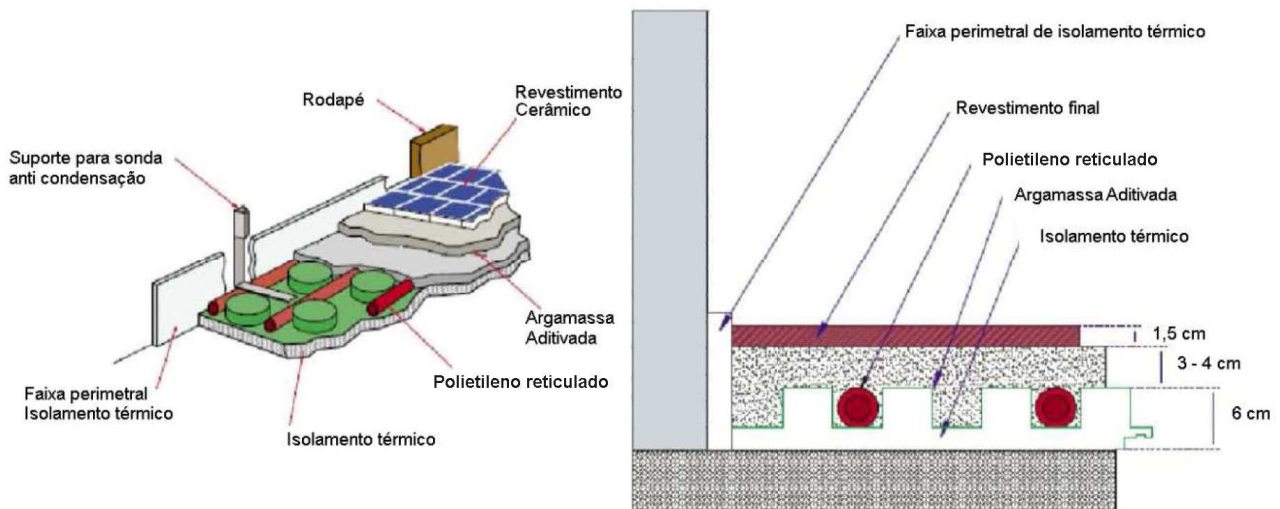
Constituição do pavimento radiante [adaptado de (Giacomini, 2012)]
